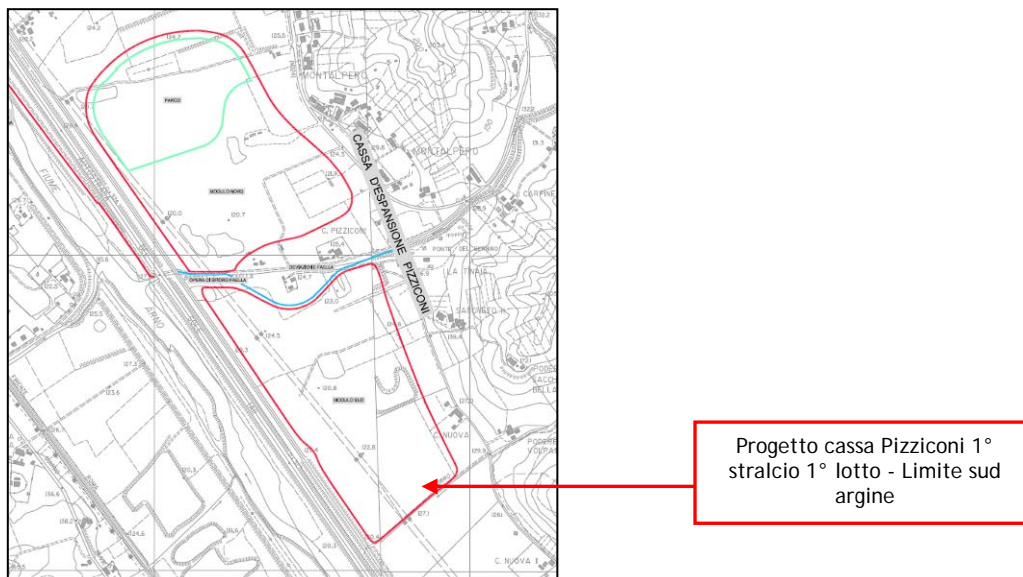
Estratto planimetria Tav. NOI 02 Planimetria degli interventi da Nulla osta idraulico Stralcio 1 Lotto 1 del 01/12/2017.
